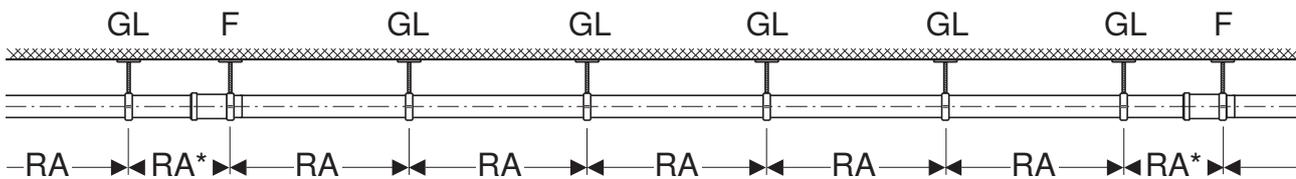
Расстояния между хомутами RA при креплении на потолках и горизонтальном креплении на стенах, без направляющих опорных желобов
